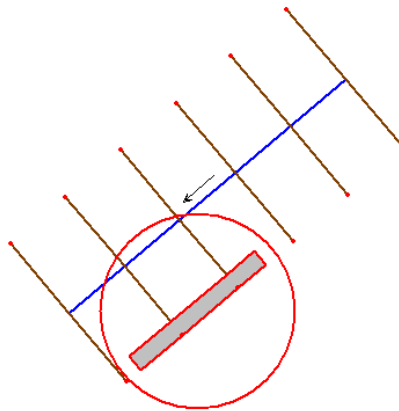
Secciones Transversales del Canal y la Estructura Lateral por donde se va romper el Canal
